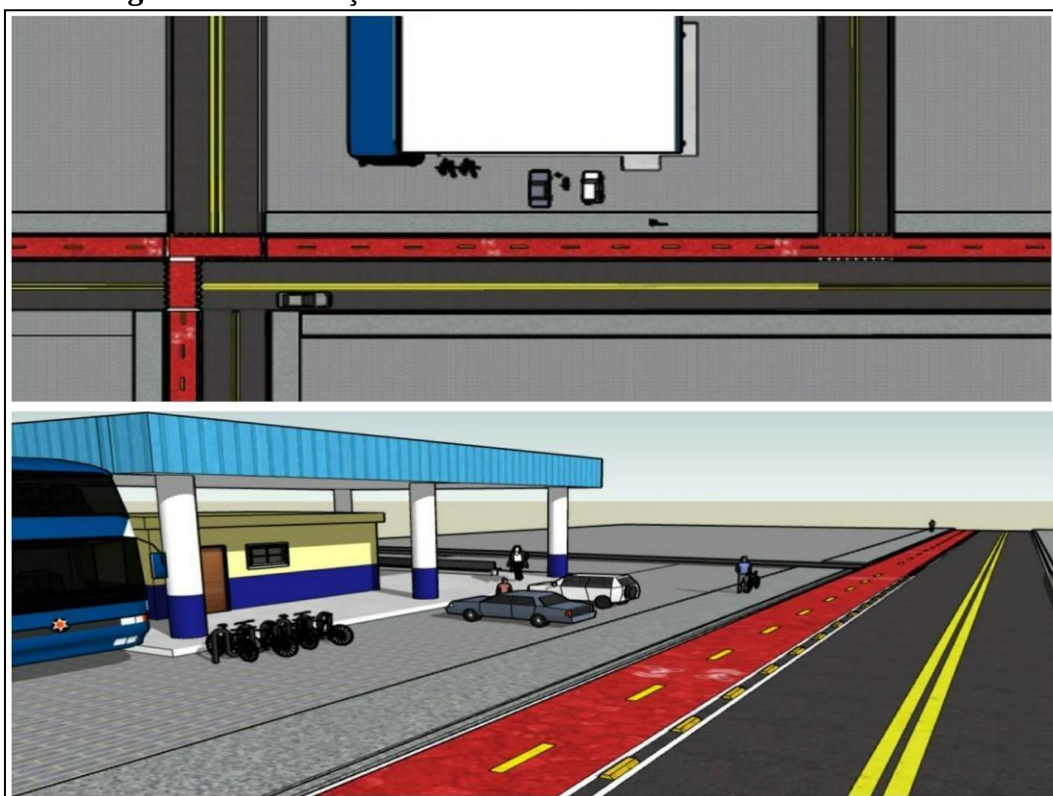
Ilustração do sistema ciclovitário no trecho 10 e 11 vista 3D
